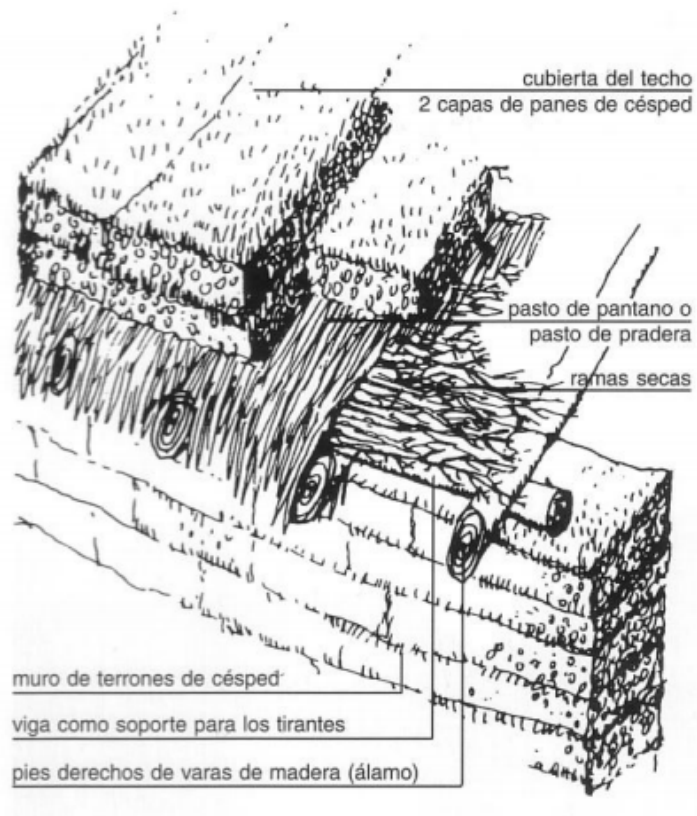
Sistema de telhado verde utilizado em Sodhouse.
